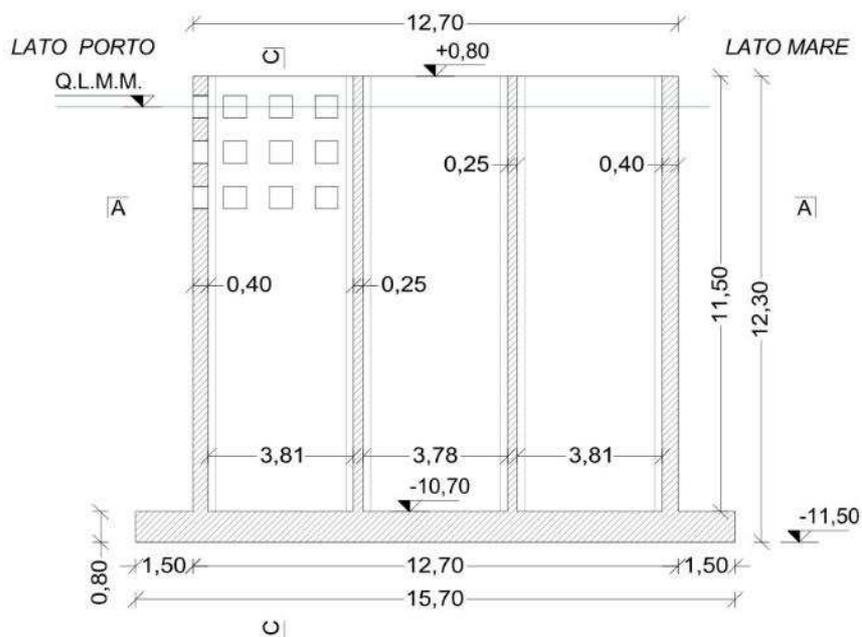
Cassoni tipo 1: Carpenteria - Sezione verticale trasversale B-B
